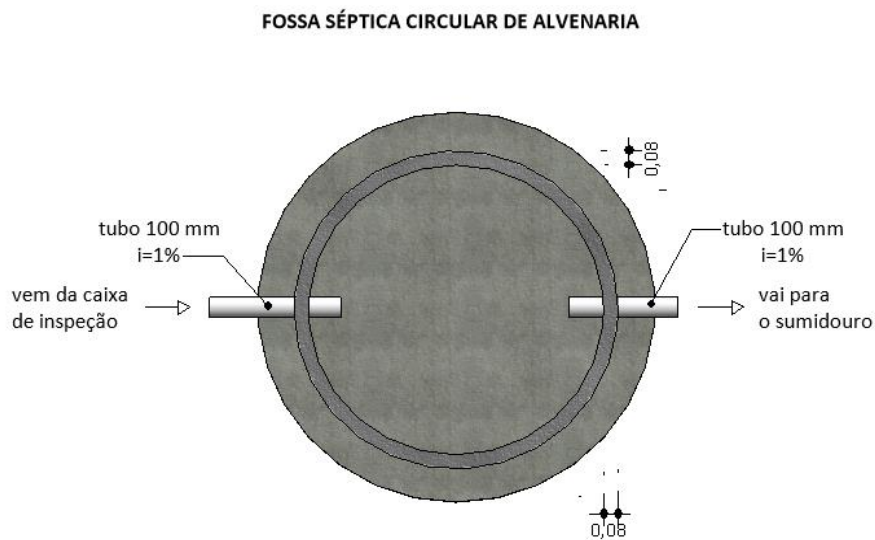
Detalhes construtivos da planta baixa de fossa séptica circular em alvenaria
